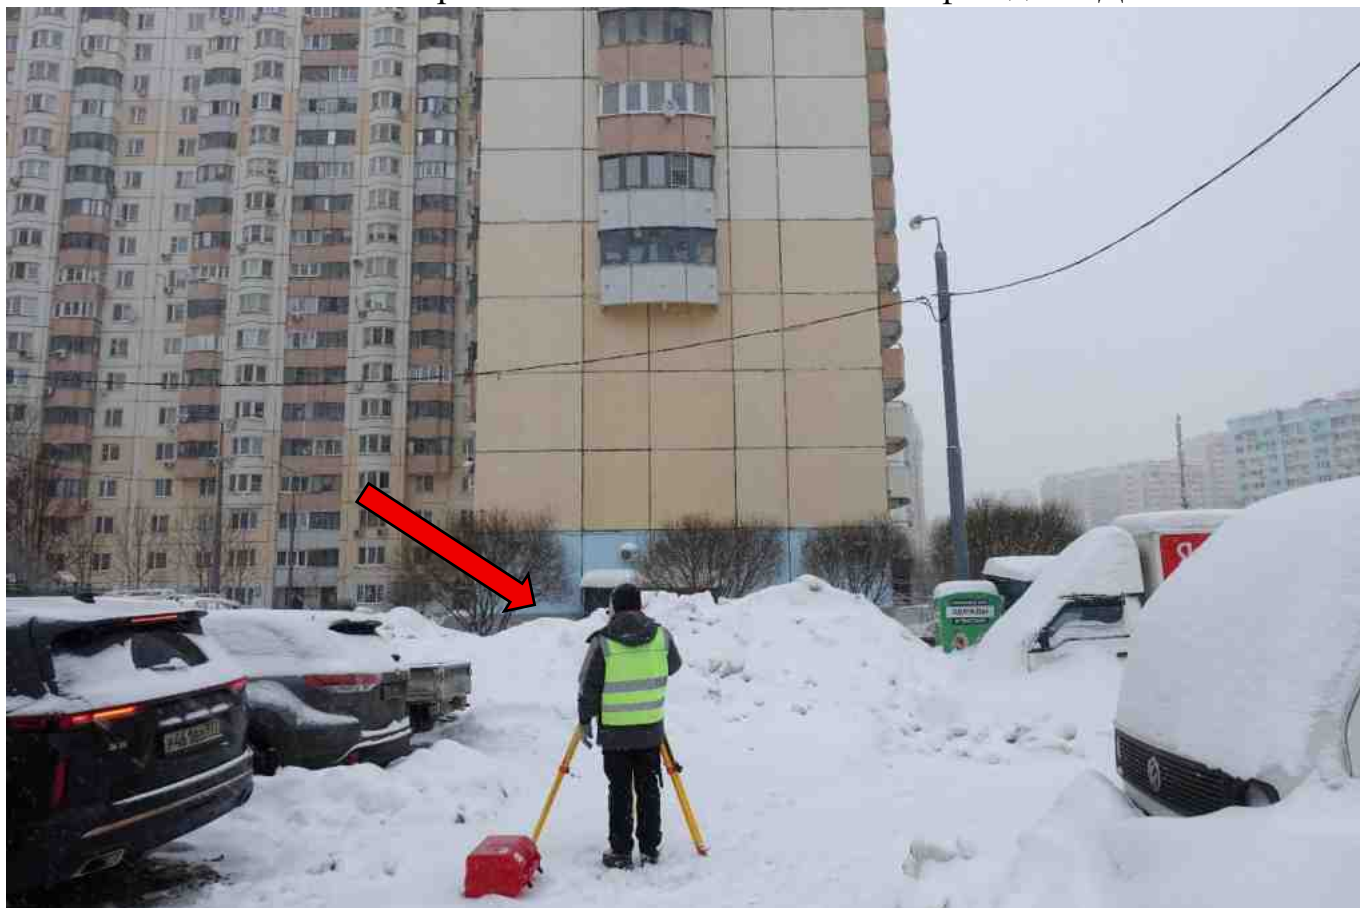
Начало осмотра фасада жилого дома от 1го подъезда.
